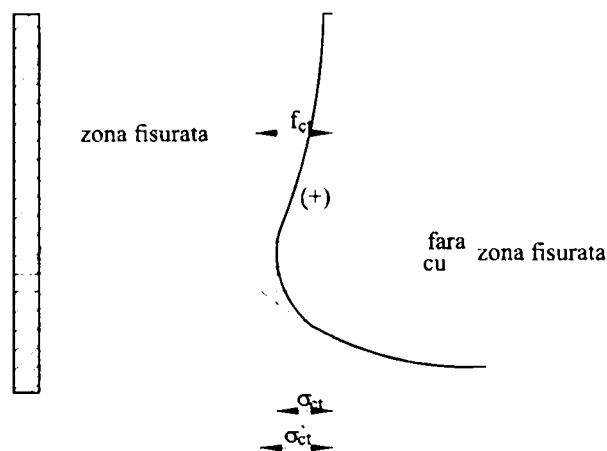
Criterii de verificare a rezistenței la întindere a barelor întinse de beton Tc în zona fisurată [39]
